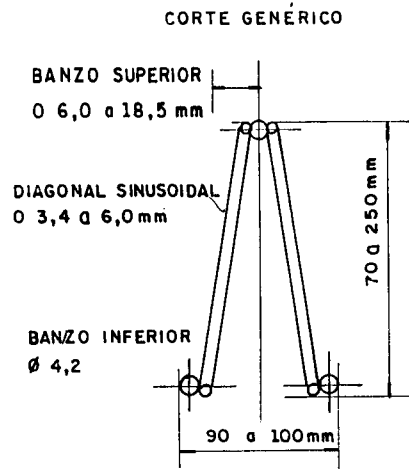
CORTE TRANSVERSAL GENÉRICO
